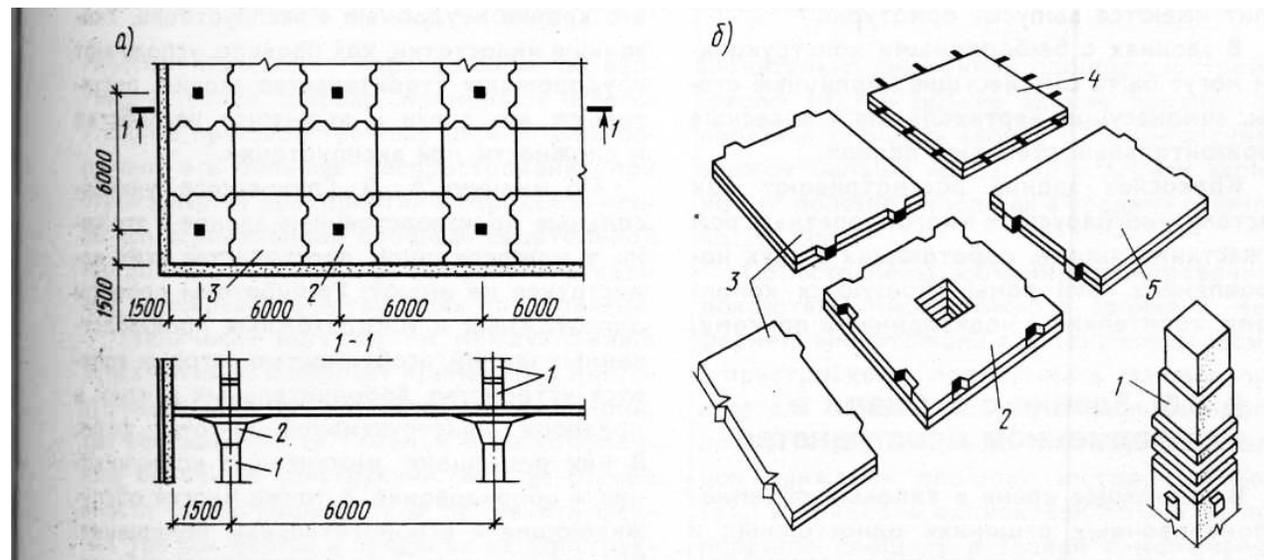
Безбалочное перекрытие с монолитной плитой:
